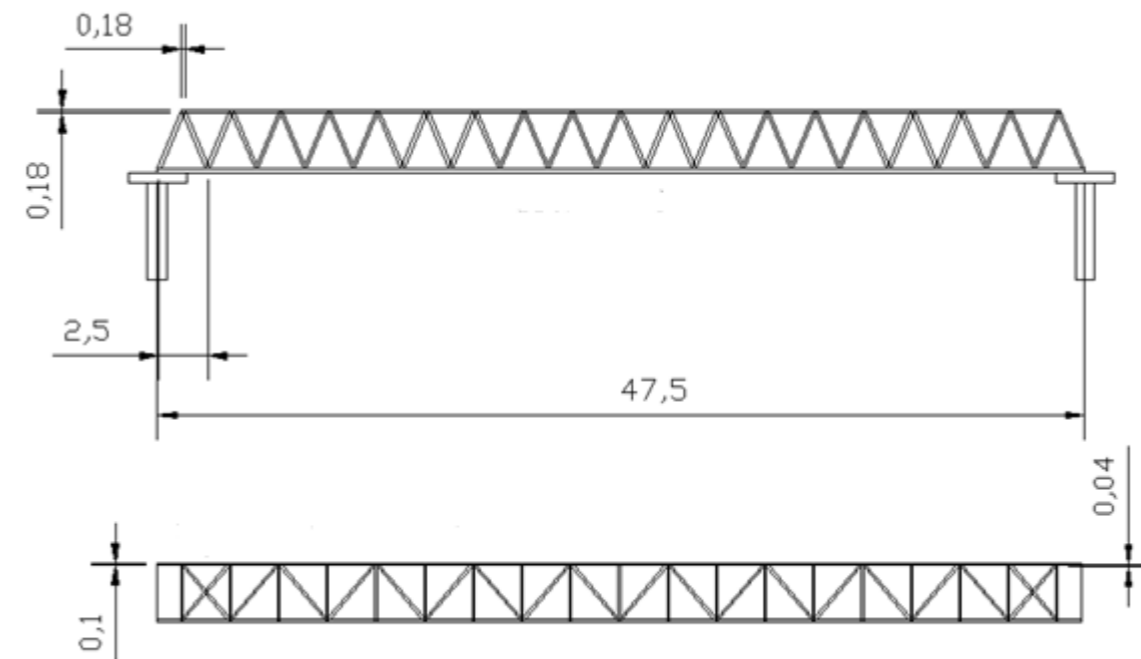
Alzado y planta pasarela peatonal tipo Warren.
